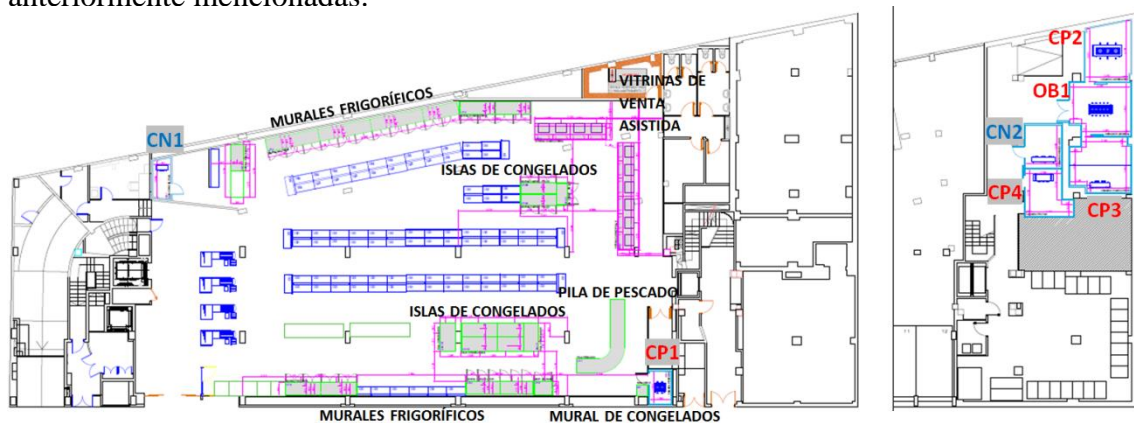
PLANO DE LA INSTALACIÓN.
